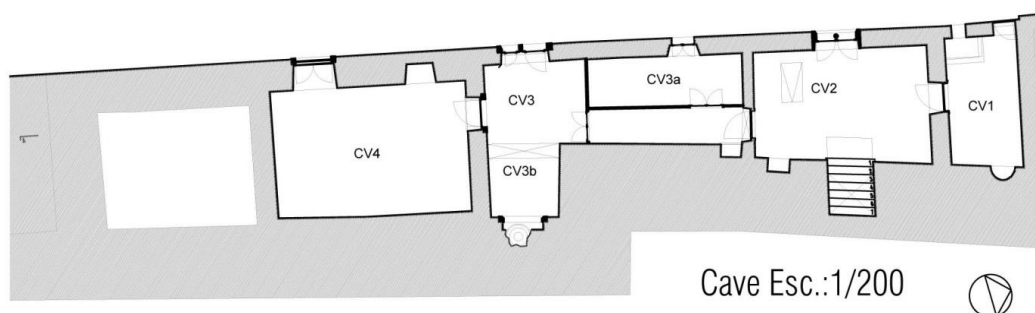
Croqui cave: Casa das Talhas – Esc.: 1:200
